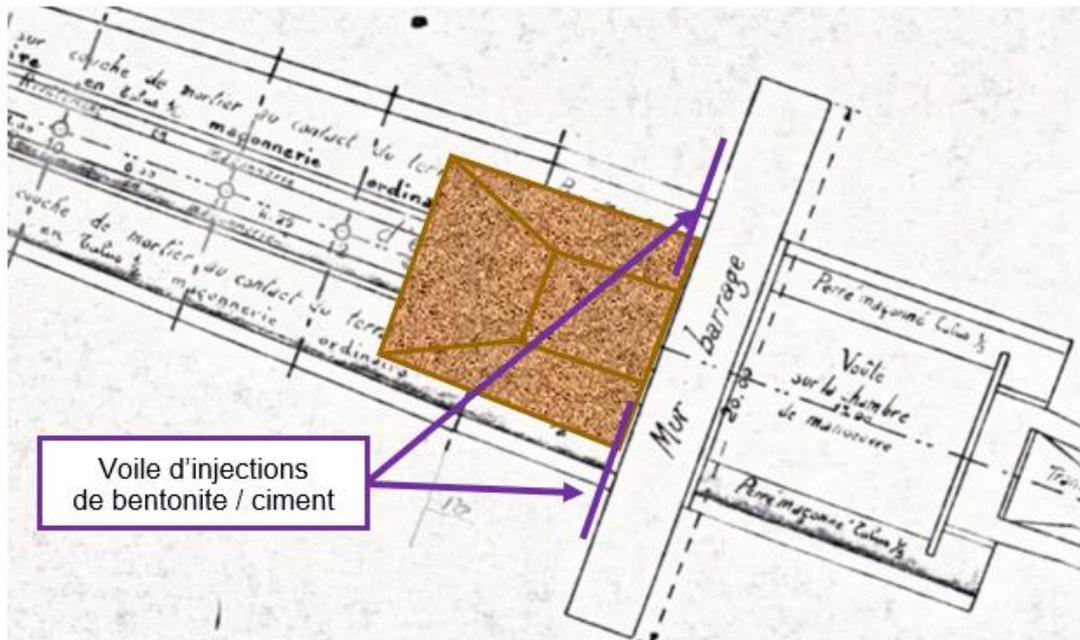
Vue en plan des injections de traitement de l'étanchéité des rives
